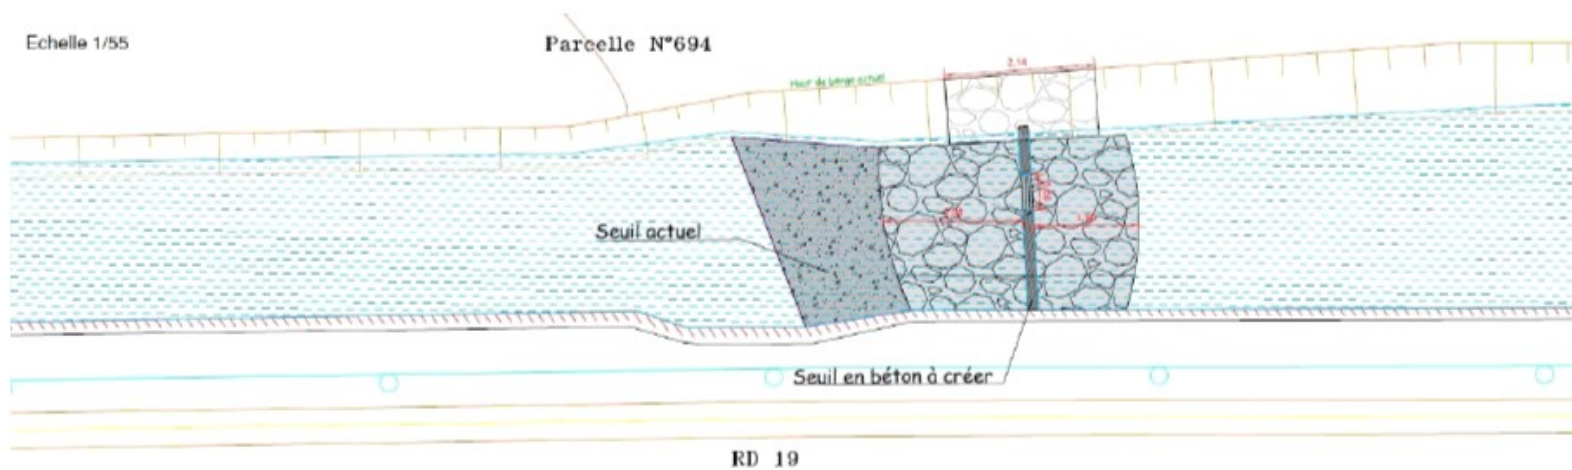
Vue en plan du pré-barrage au niveau du seuil de la RD19
